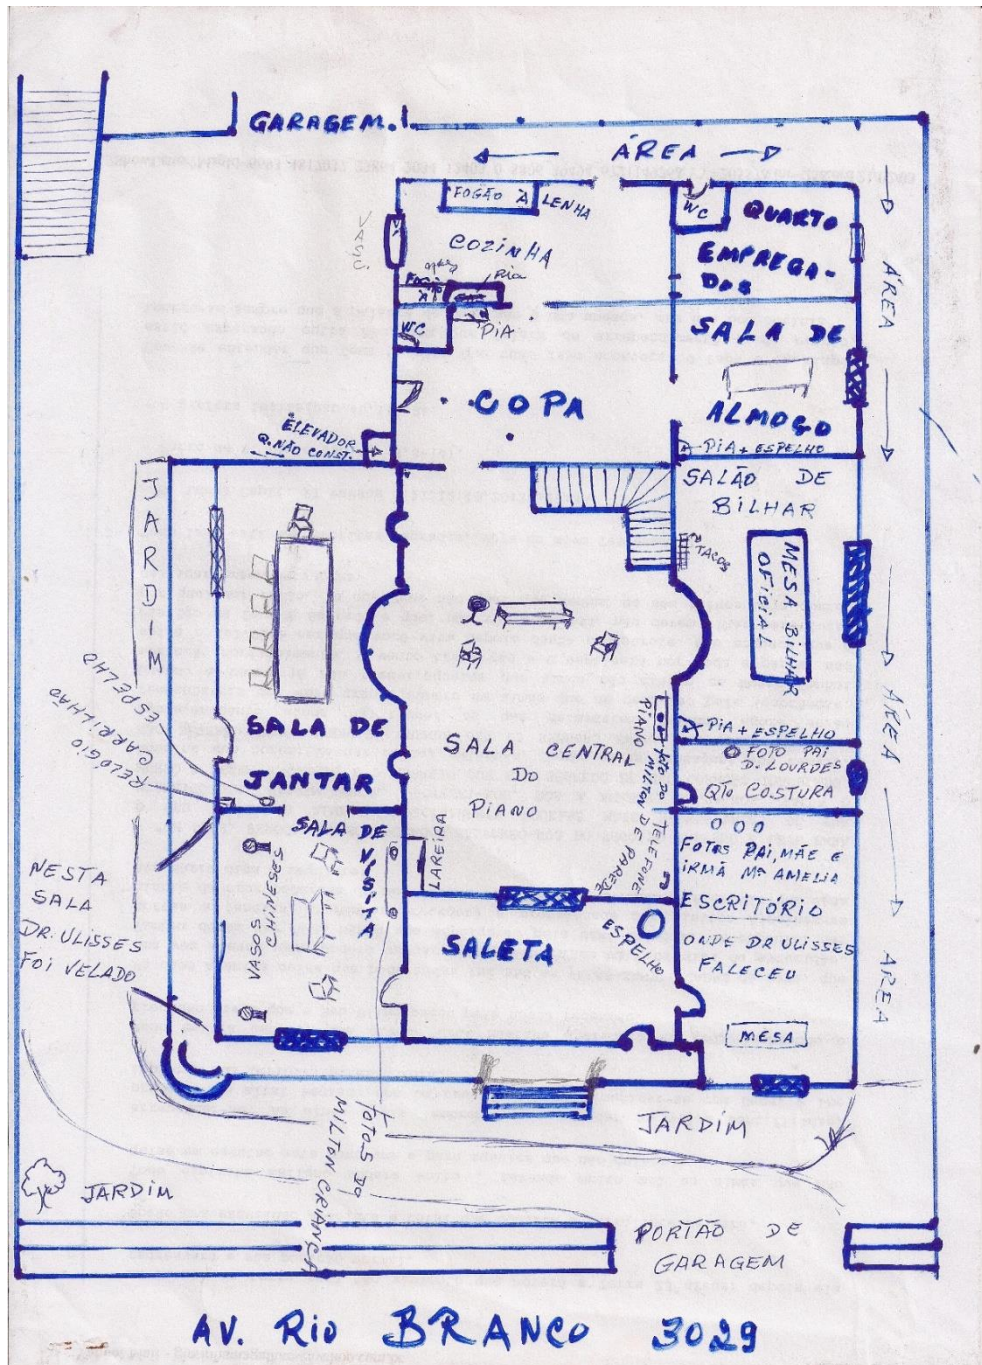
Croqui da planta do primeiro pavimento do Castelinho
